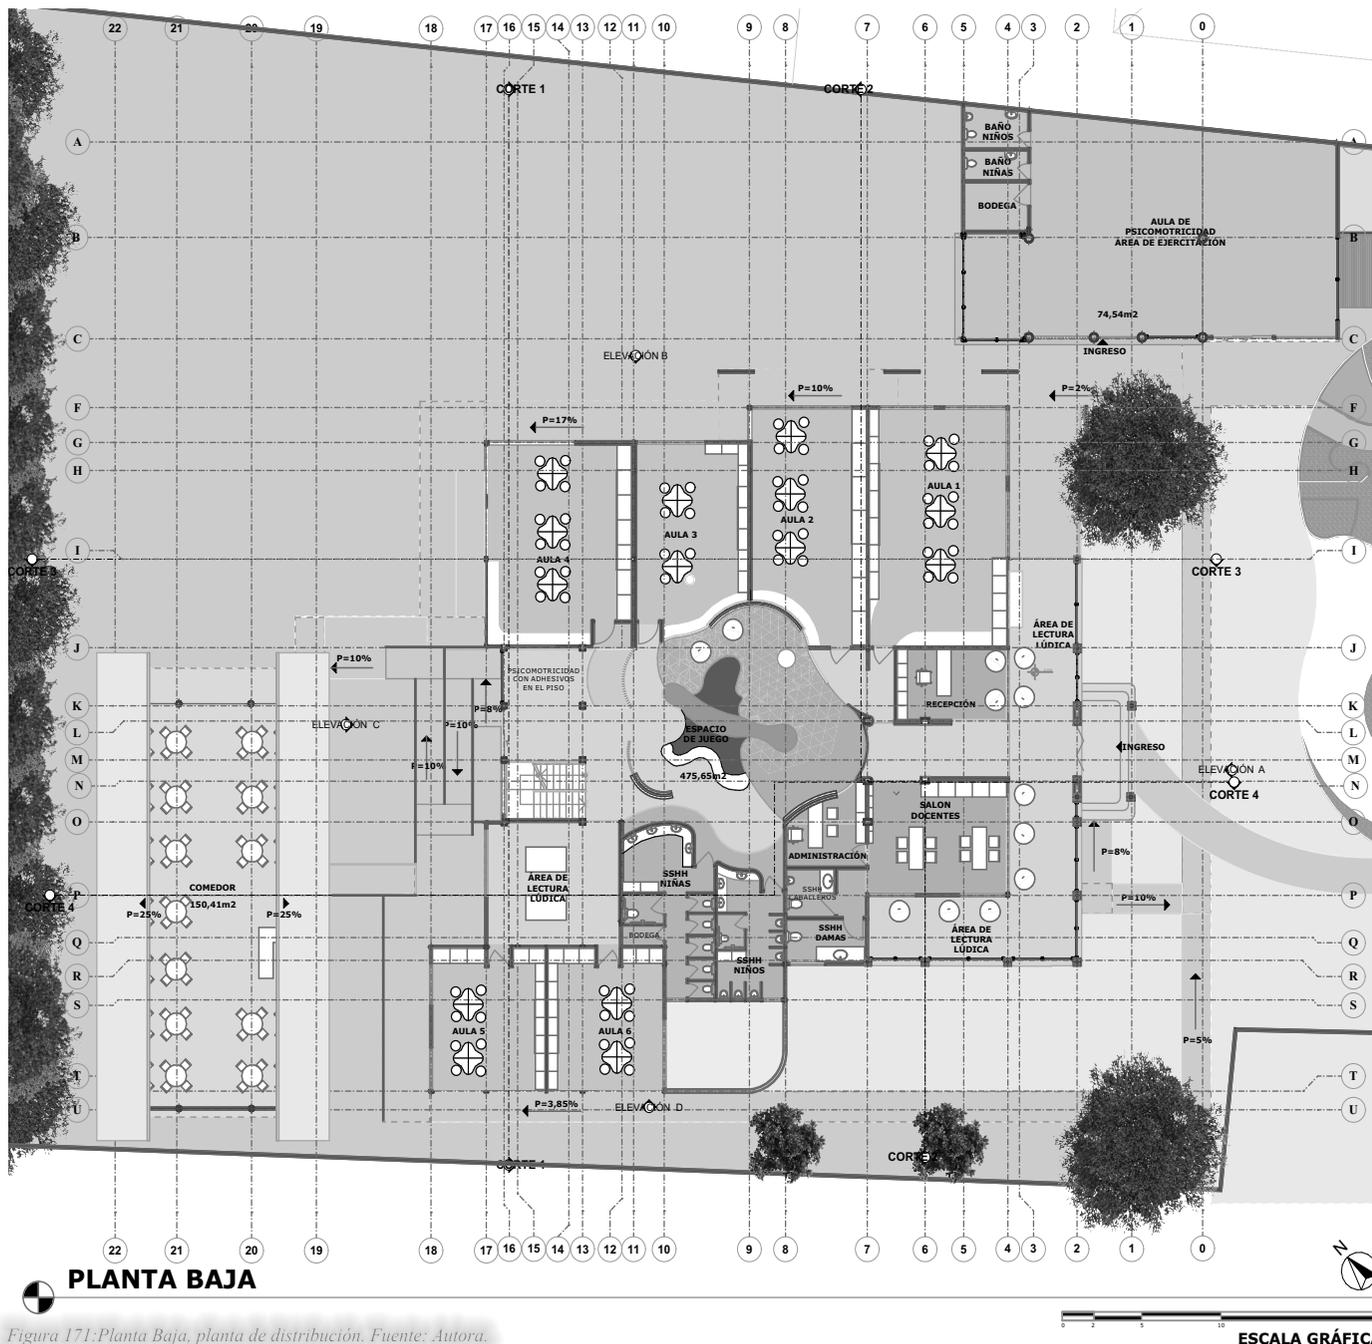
Planta Baja, planta de distribución. Fuente: Autora.
